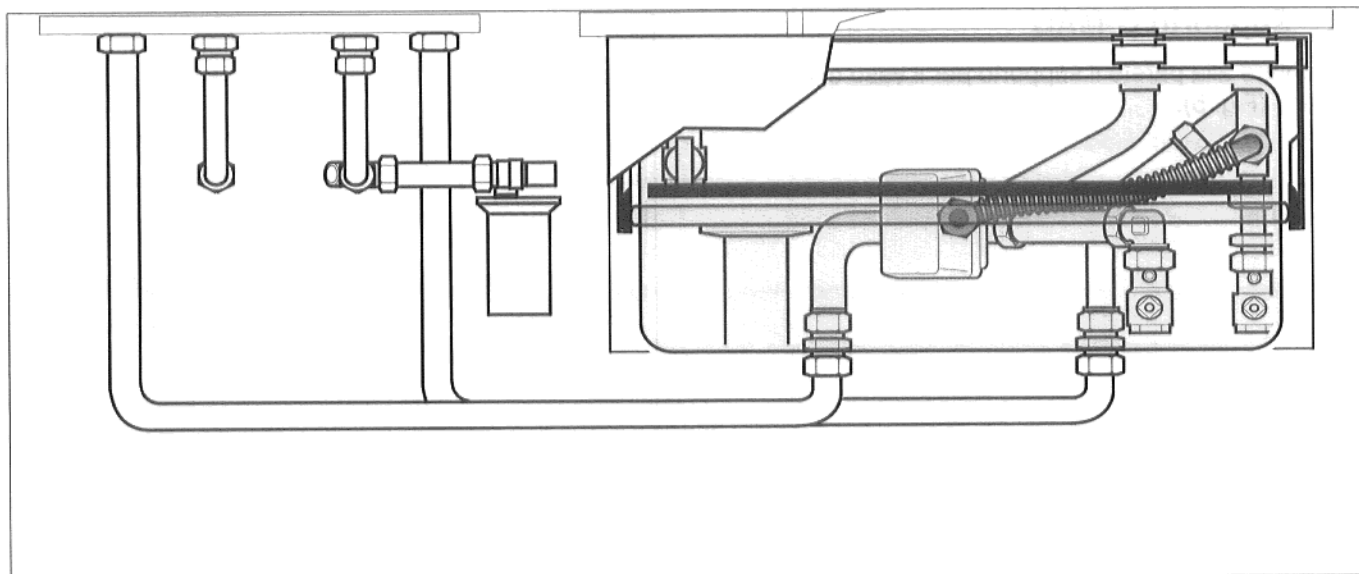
schema di montaggio per GB112-24/W oppure -29/W con HT75 a sinistra
